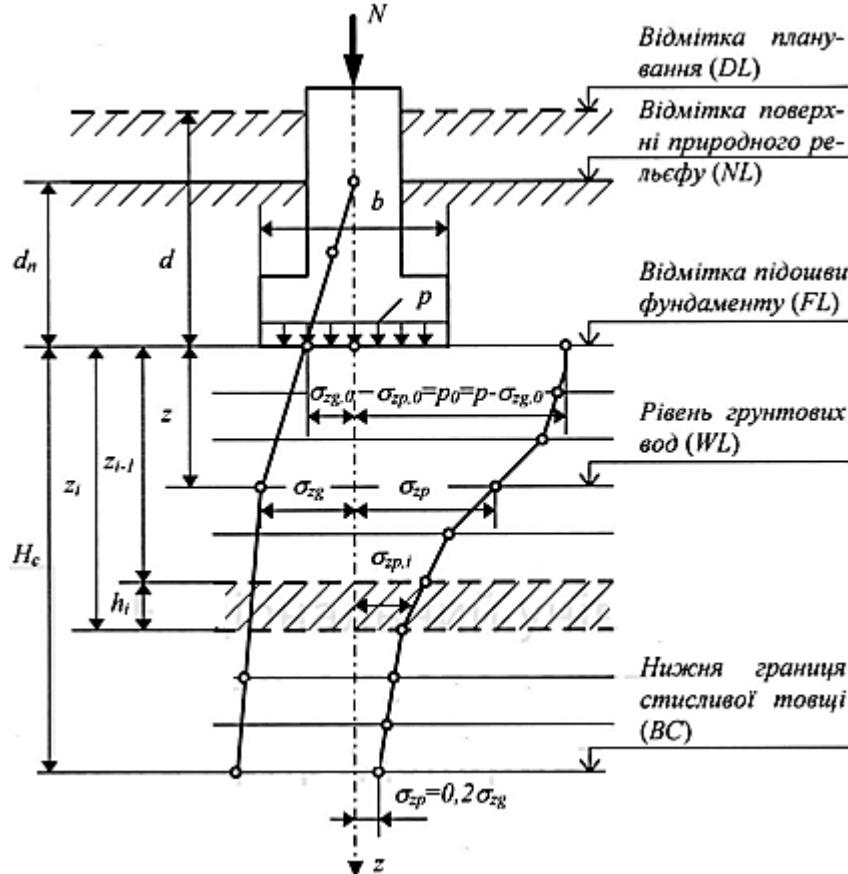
Епюри напружень під підшовою фундаменту за методом пошарового підсумовування
